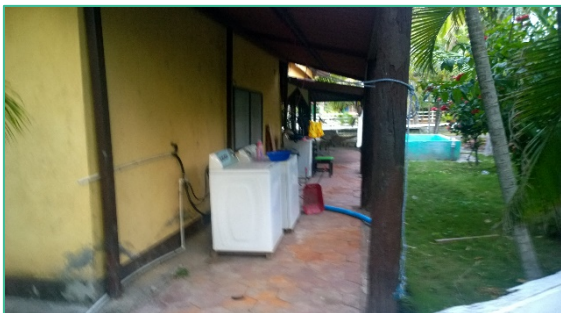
Área de Lavandería. Fuente: Propia del Autor
